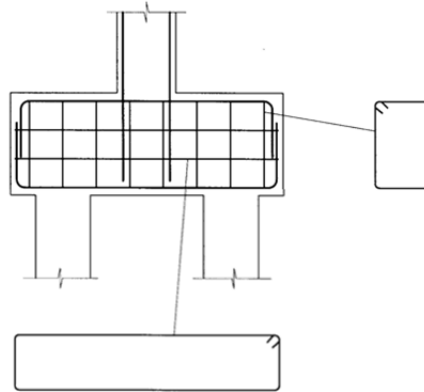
Armadura secundaria encepado sobre dos pilotes
